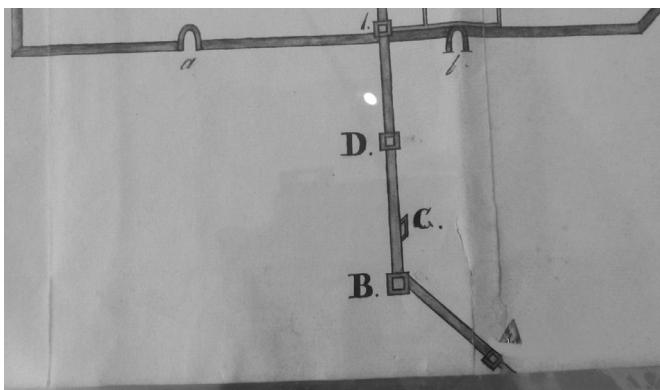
Aqueduto. Planta esquemática. Troço entre S. Bento e a muralha
